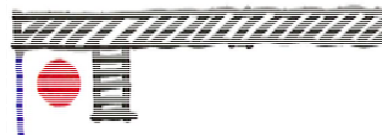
Parallelführung zum Randbalken Balken bleiben sichtbar z.B.: für Lüftungsführung bei Schwimmbädern
